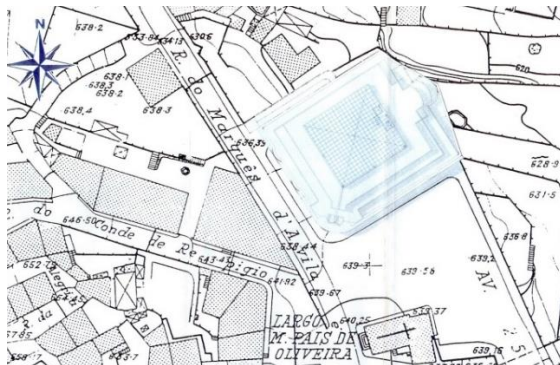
Proposta da IMABEL - Planta de implantação, jan 2004
